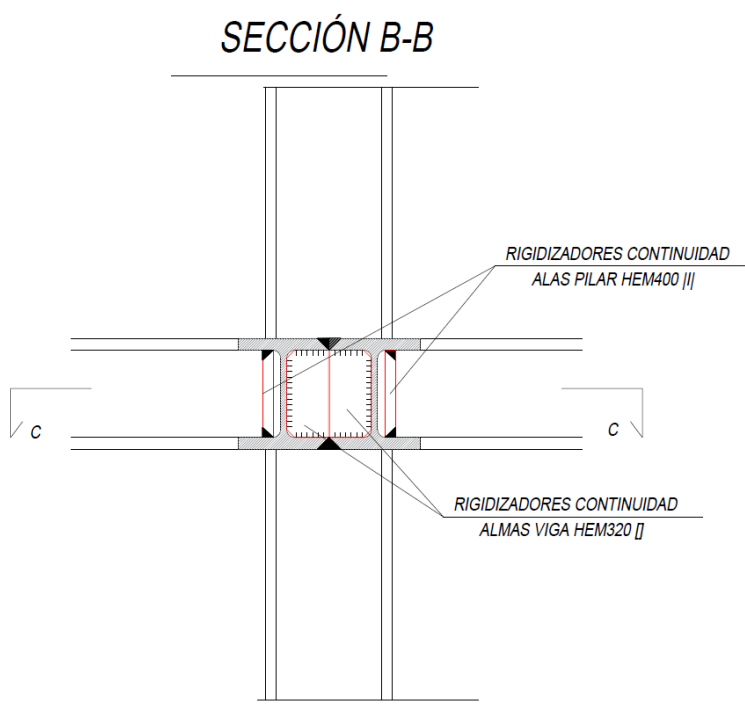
Sección con rigidizadores de pilar HEM400 y de viga doble HEM320.
